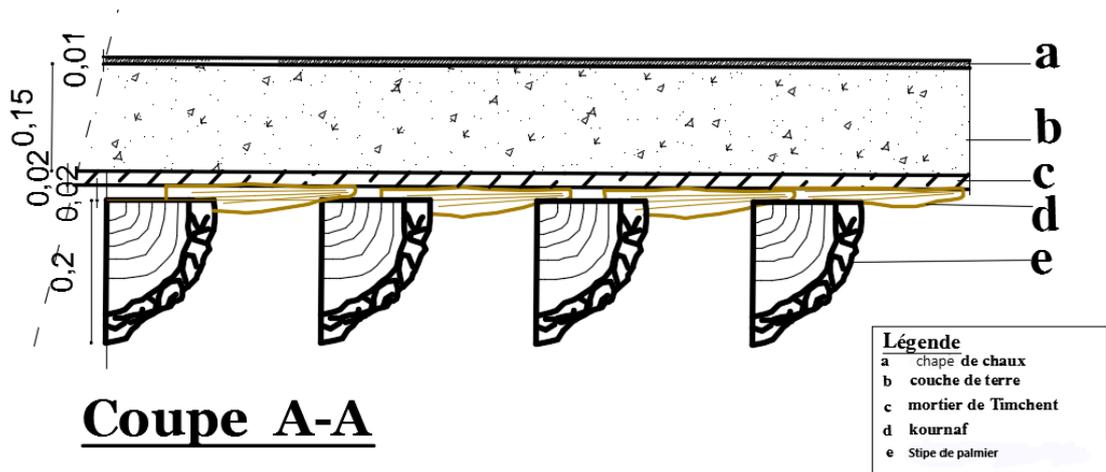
Détails constructif du plancher traditionnel. Source : les auteurs 2019.
